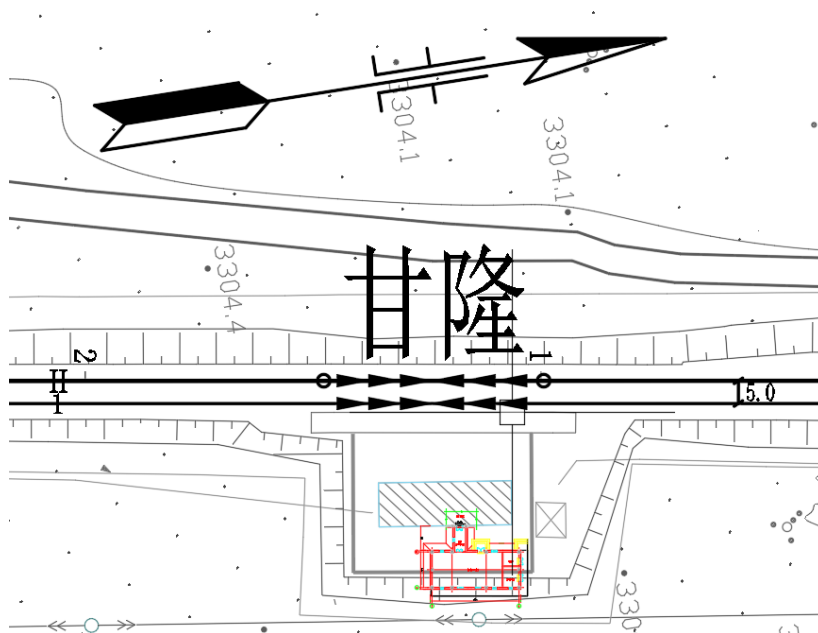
甘隆站接建信号机械室平面布置示意图（典型）
